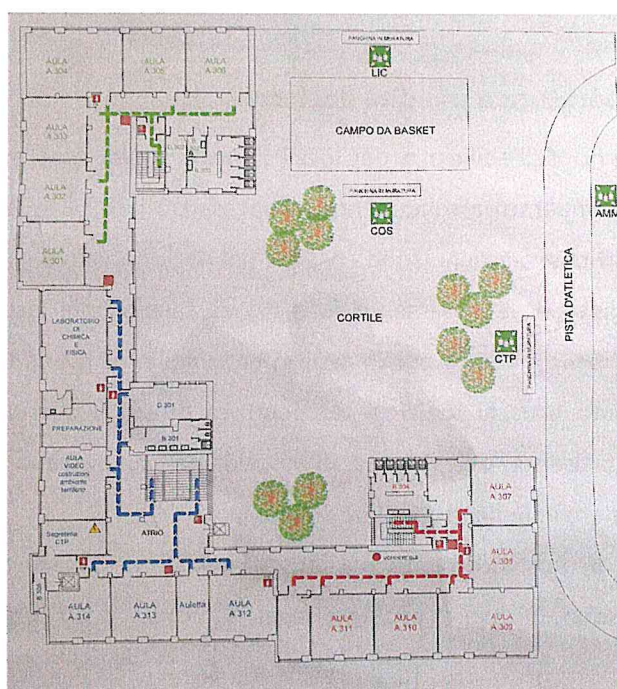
Esempio di planimetria d'emergenza esposta nell'istituto
